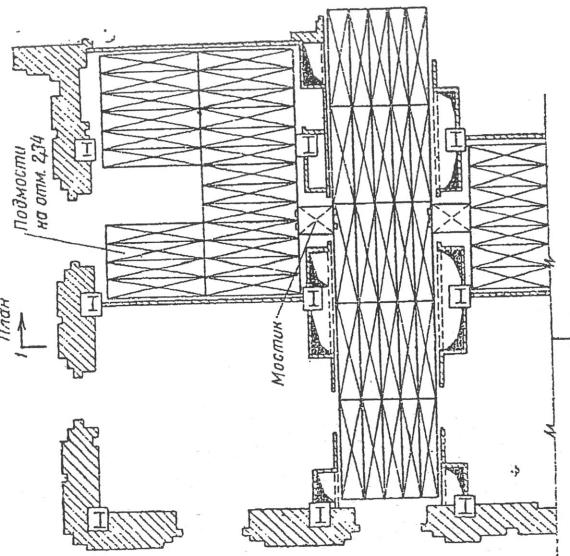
Второй этап — кладка междукомнатных стен до отметки 2,34 м, коридорных до 2,46 м.
